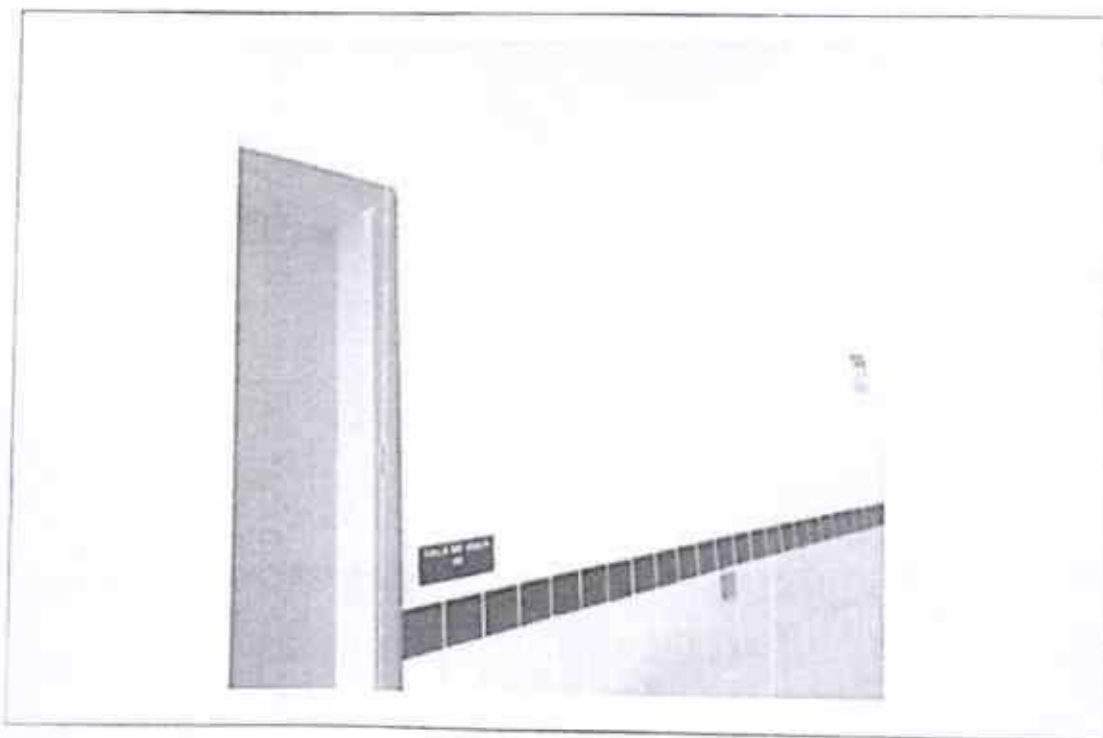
Fissuras superficiais no corredor superior de acesso as salas de aulas.
